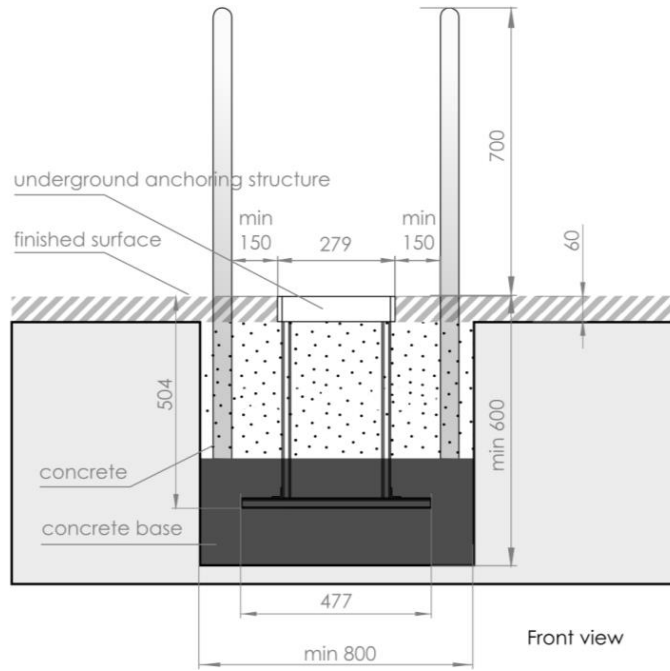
sezione longitudinale dello scavo con due archi di sicurezza
